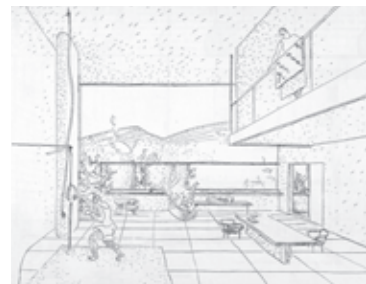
Dibujo de les inmuebles villes de LC construcción en seco.
